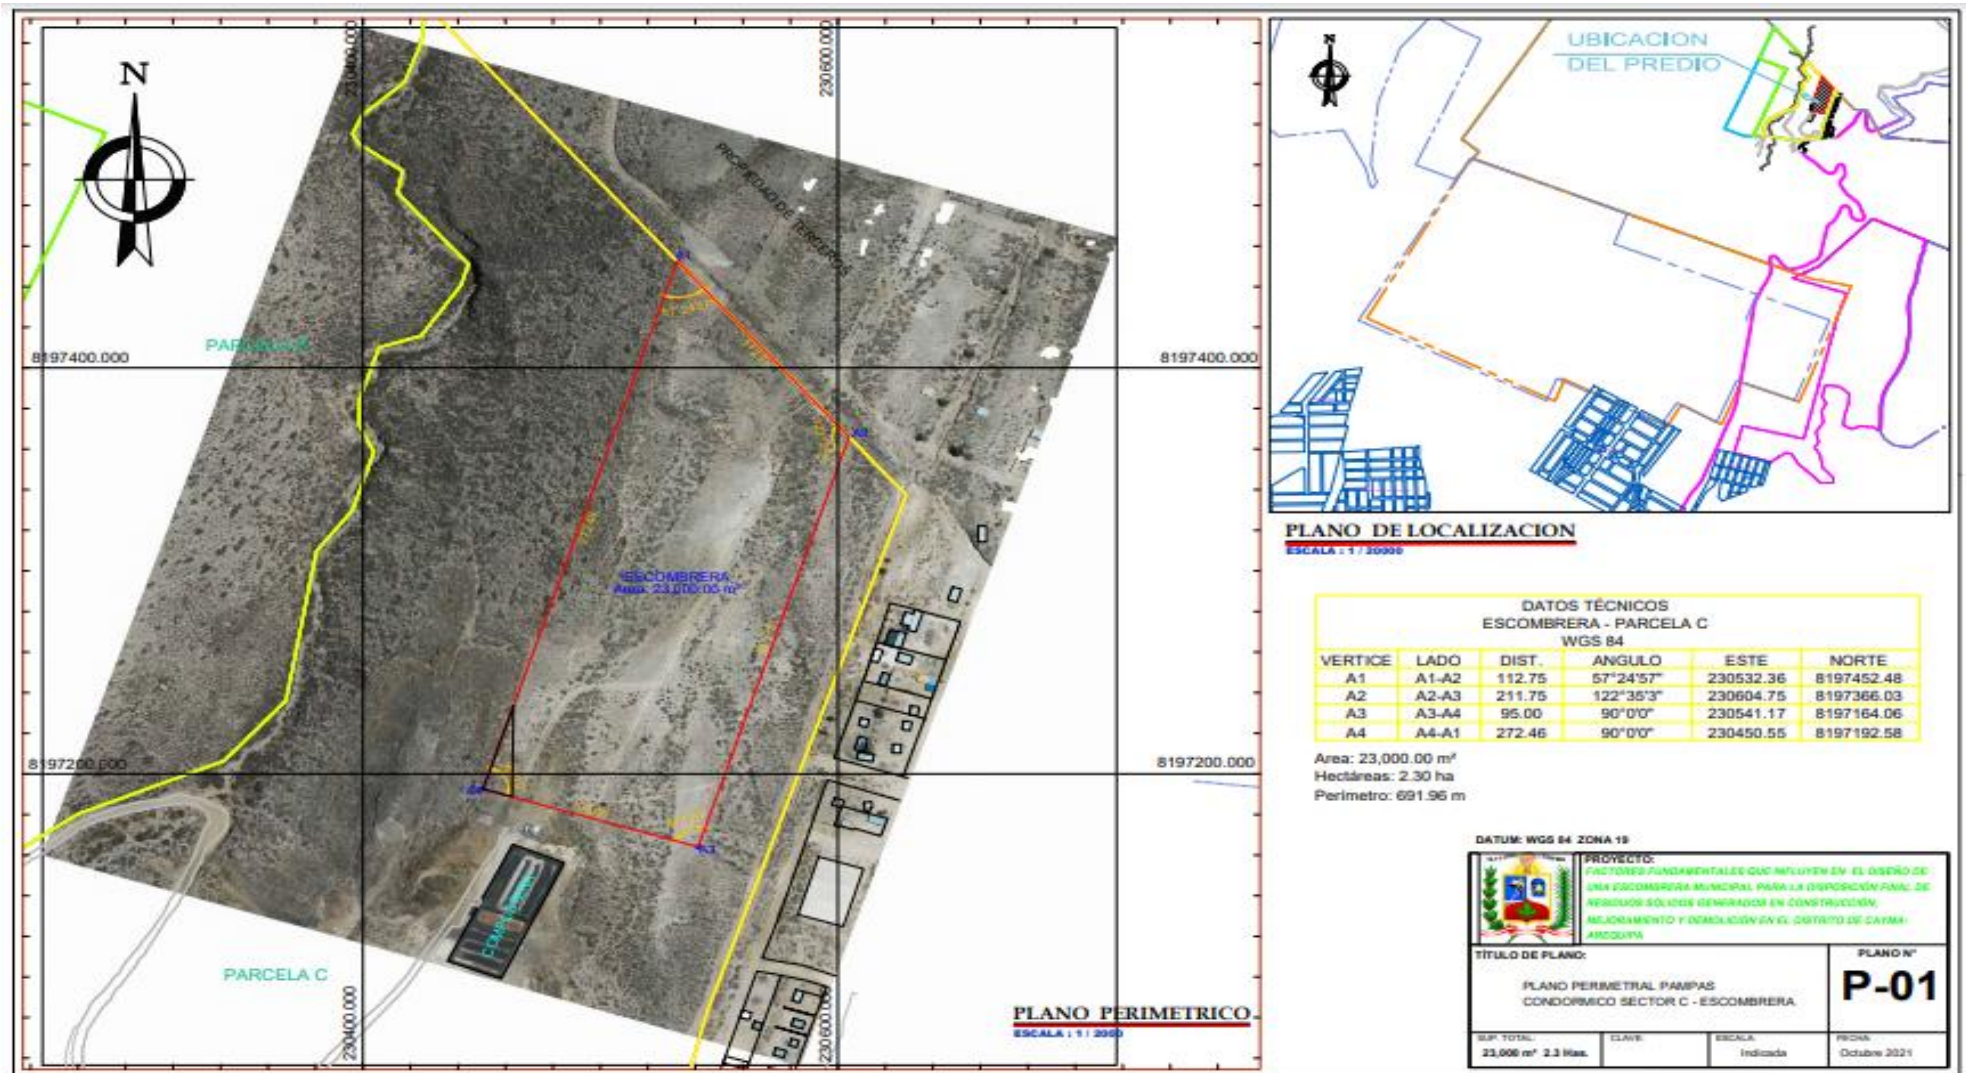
Plano Perimetral de las Pampas Condormico Sector C - Escombrera
